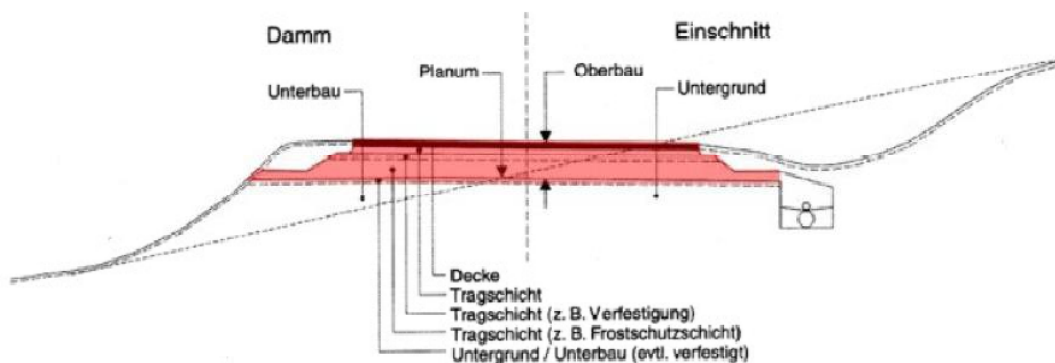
Straßenoberbau außerhalb geschlossener Ortlage gemäß RStO
